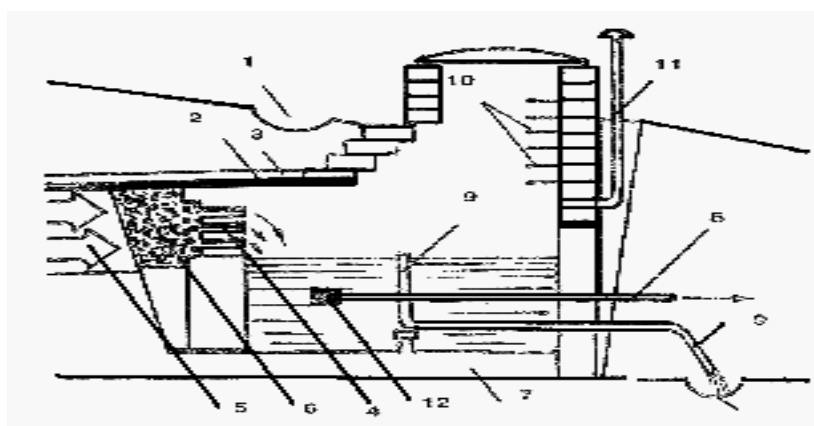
Каптаж нисходящего родника: 1 - водотводной желоб; 2 - гидроизоляция; 3 - плита перекрытия; 4 - дренаж; 5 - водоносный слой; 6 - гравийный фильтр; 7 - бетонное основание; 8 - водозаборная труба; 9 - переливная труба; 10 - скобы; 11 - вентиляционная труба; 12 - фильтр водозабора.
